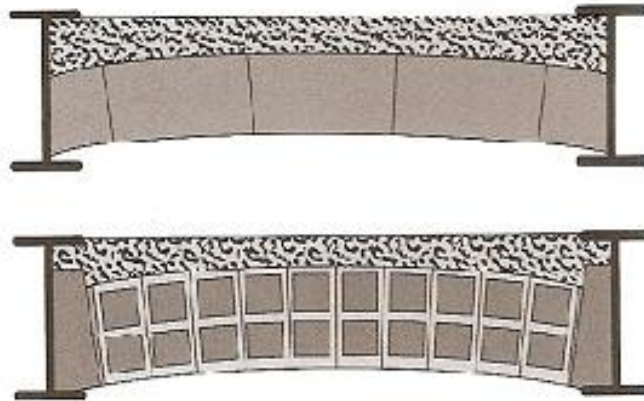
Pavimentos de estrutura metálica [adaptado de ANDRADE]
